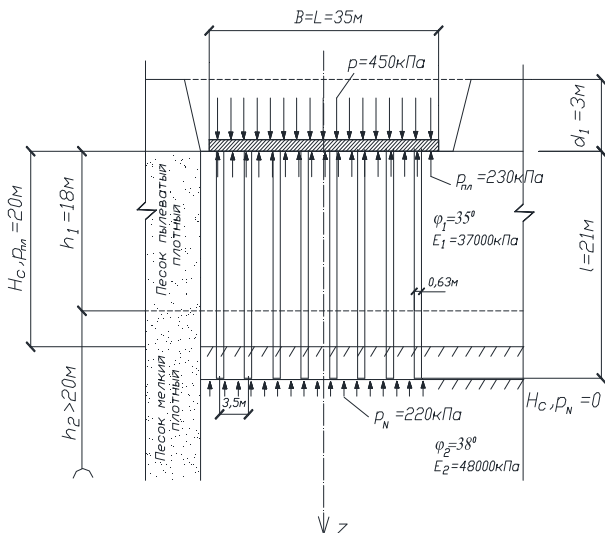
Расчетная схема взаимодействия принятого варианта плитно-свайного фундамента с грунтовым основанием
